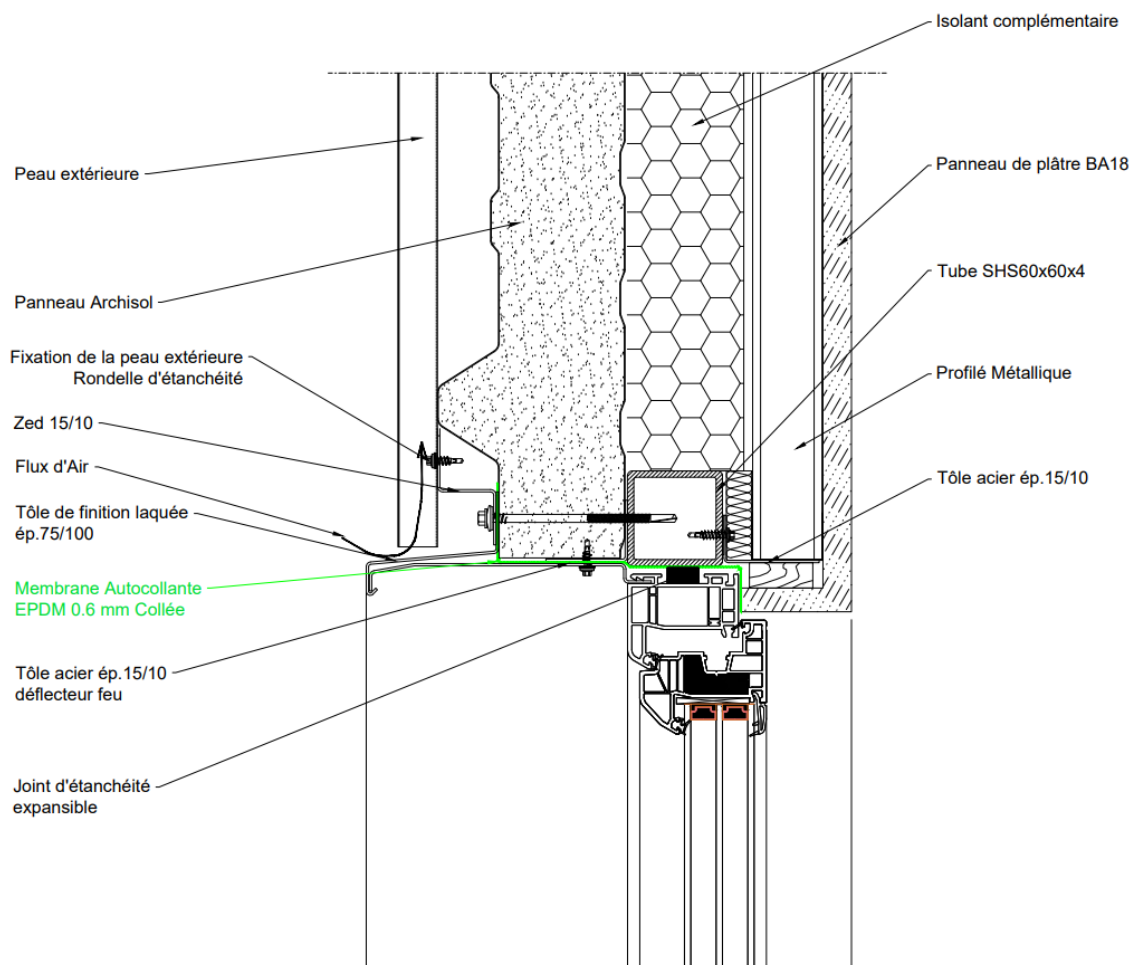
Coupe verticale sur la jonction linteau - D2B Archisol - Pose directe.
